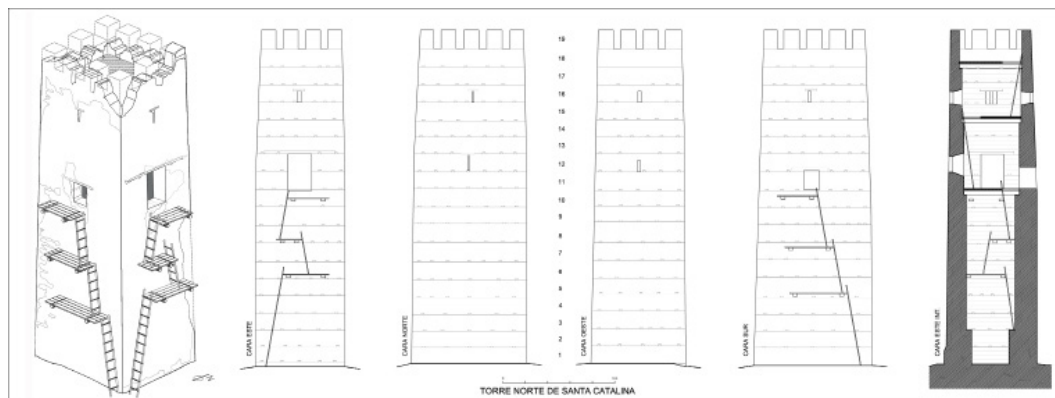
Hipótesis sobre la configuración primigenia de la torre Norte de Santa Catalina. En los alzados y sección se ha señalado la disposición de los cajones y mechinales de aguja visibles. Sur, al fondo la torre Norte.
